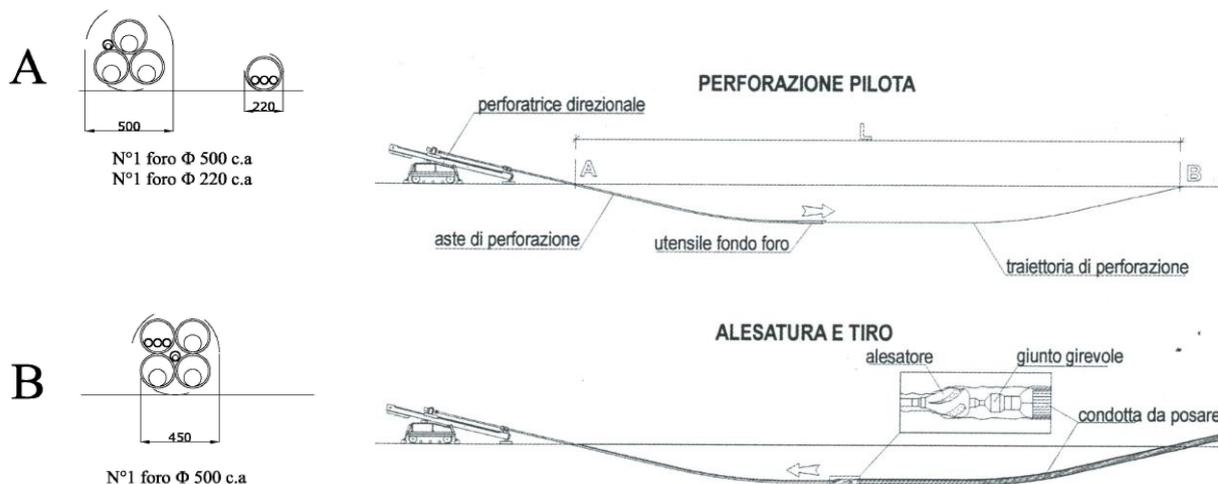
Tipico attraversamento stradale longitudinale e trasversale
